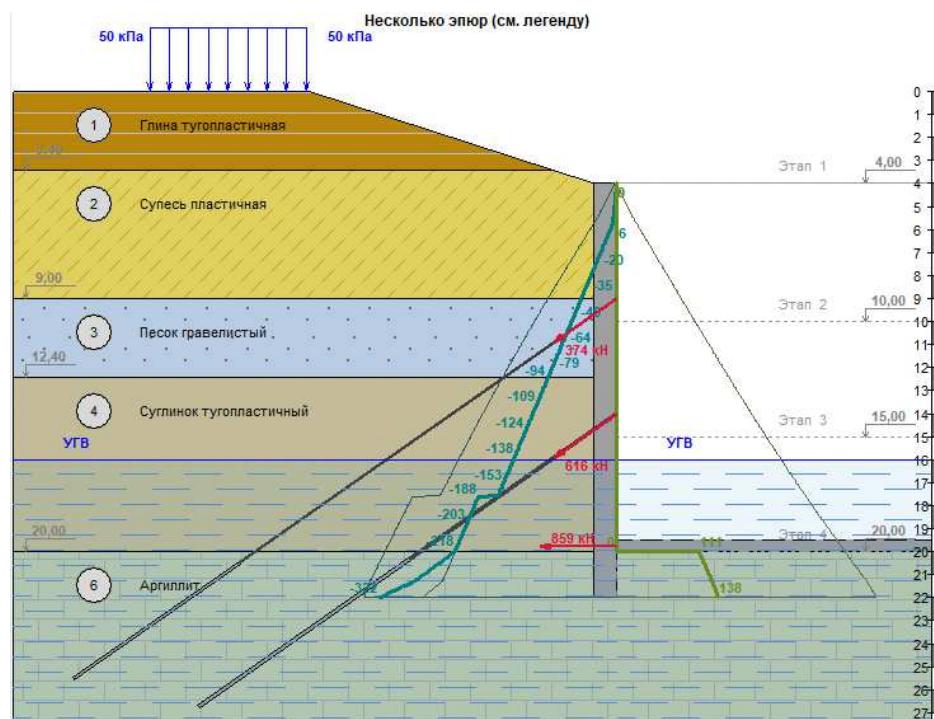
4 этап: разработка котлована до его дна и устройство фундаментной плиты
